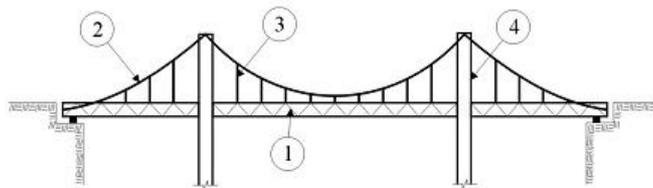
Esquema de uma ponte Pênsil: 1 viga metálica; 2 cabo portante; 3 pendurais de suspensão de vigamento no cabo portante; 4 torres de apoio do cabo portante (Fonte: VITÓRIO, 2002).
